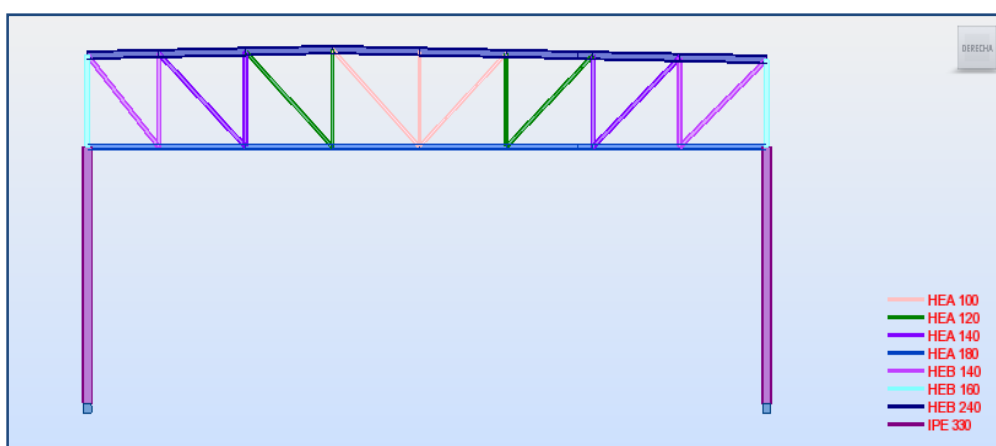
Alzado de celosía 1 o Interior (Modelo estructural del proyecto)
